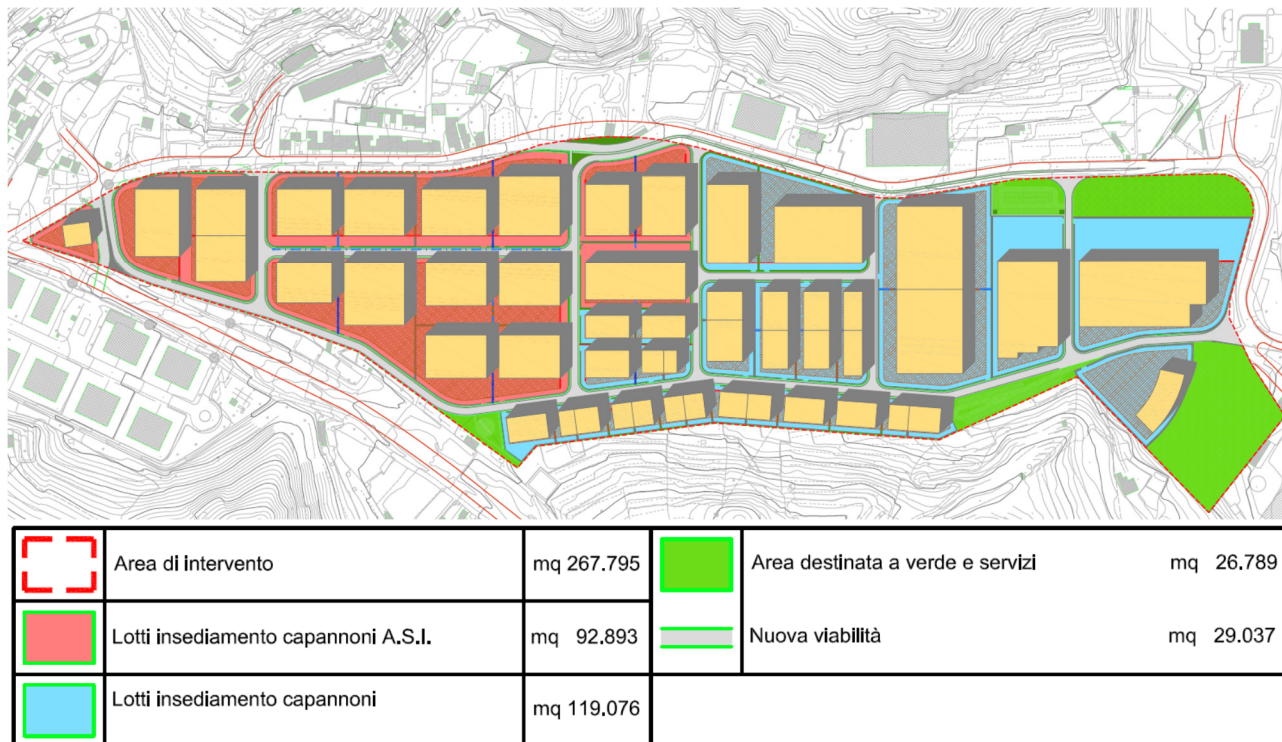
Planivolumetrico Piano particolareggiato P.I.P. approvato
